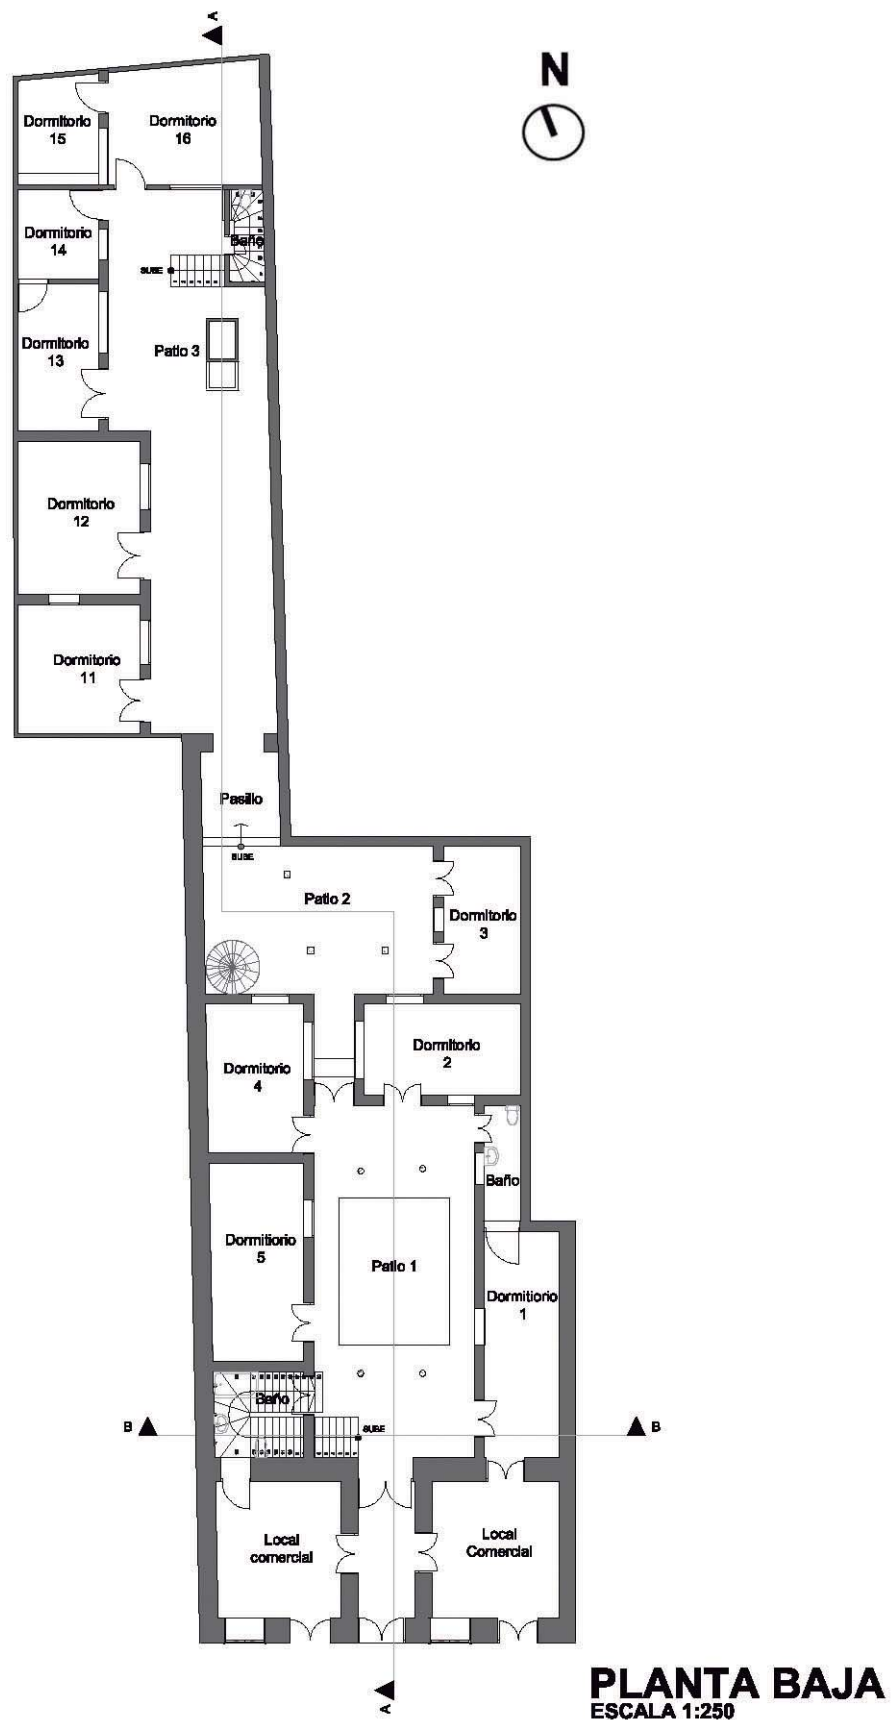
Redibujo de la planta baja de la casa Serrano Abad. Previo a intervención de restauración 2013.
